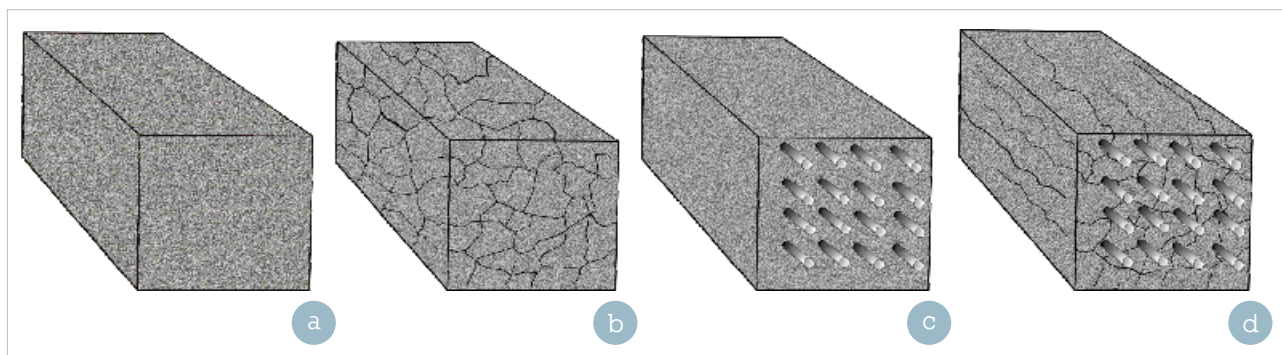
Influência da distribuição das armaduras na tipologia de fissuras em elementos de concreto sujeitos à expansão interna induzida por R.A.A
